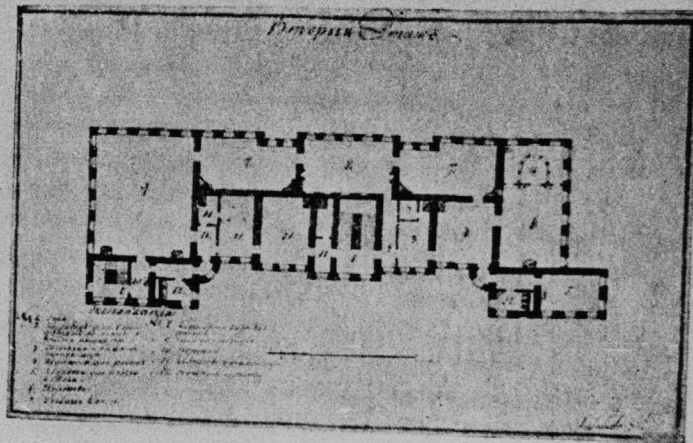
План второго этажа старого здания училища. Арх. И. Жиларди. ЦГИАЛ
